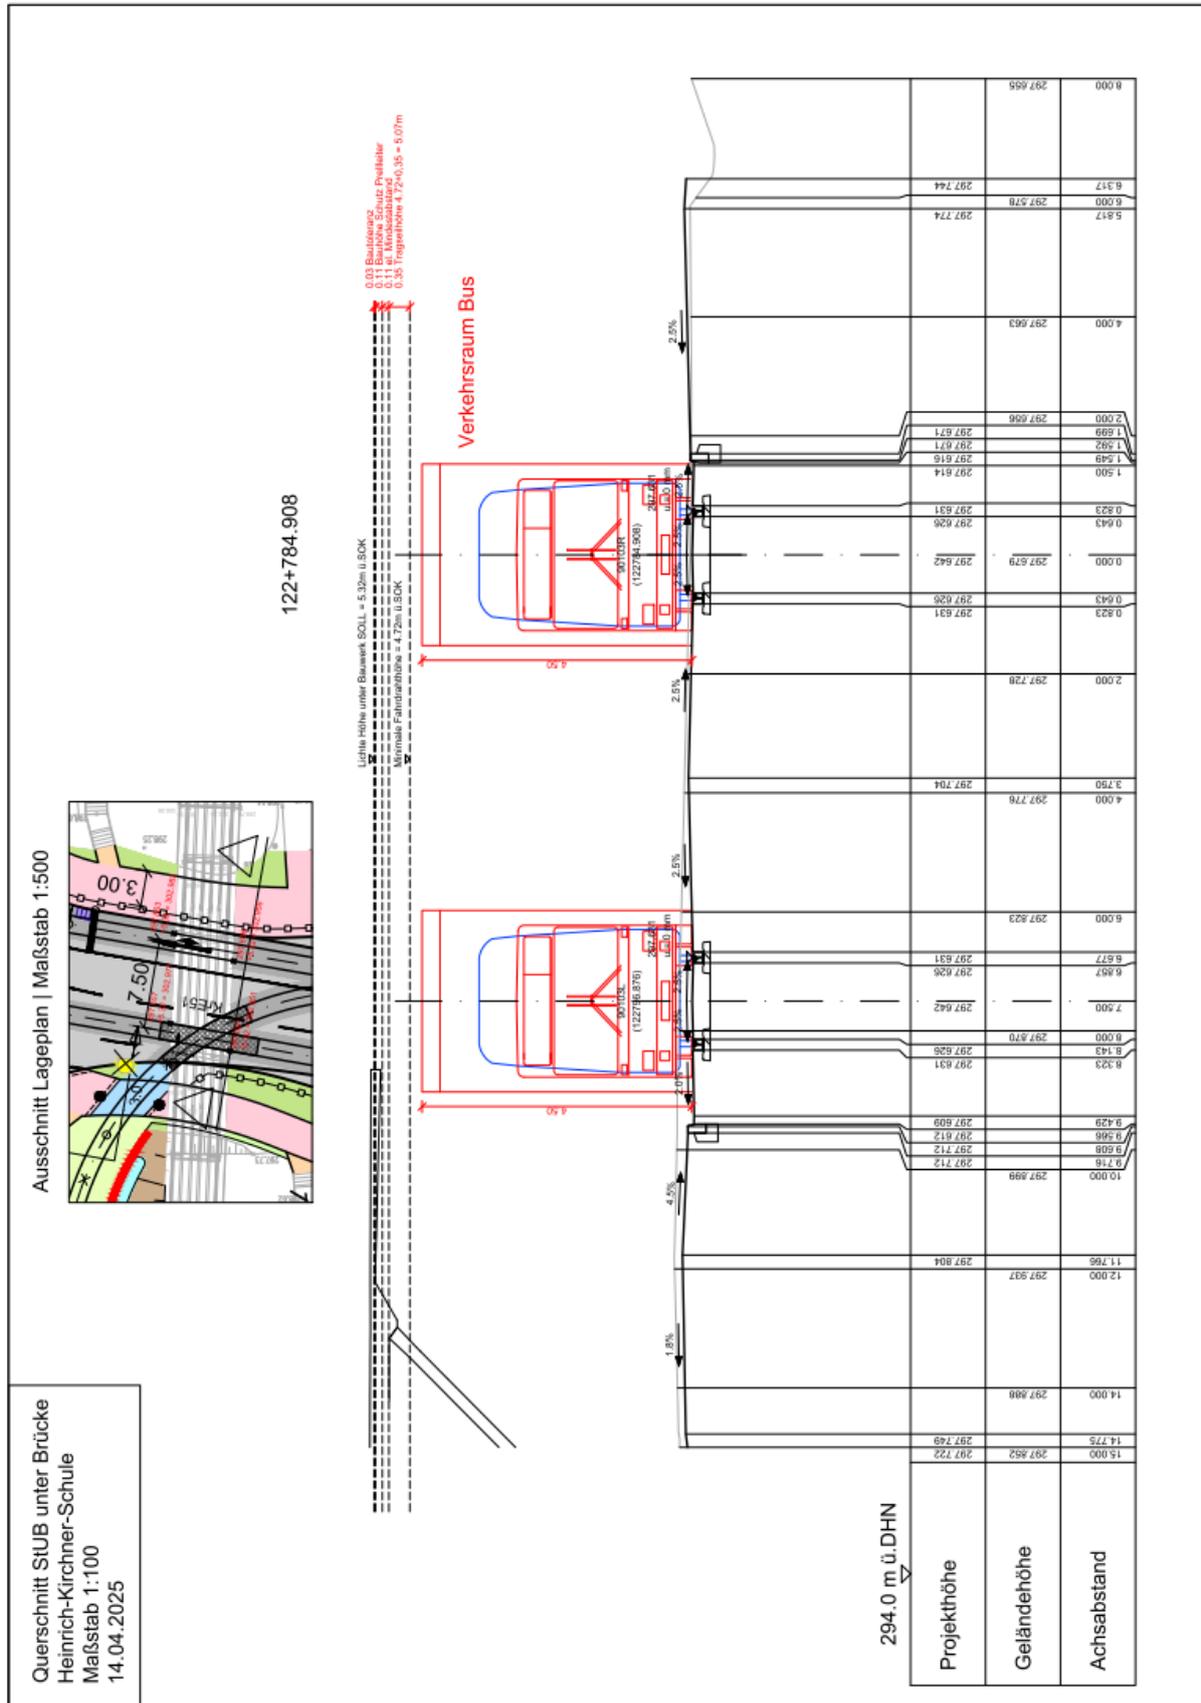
, Querschnitt StUB unter Brücke, Ausschnitt Lageplan, v. 14.04.2025 Quelle: Tiefbauamt Stadt Erlangen
